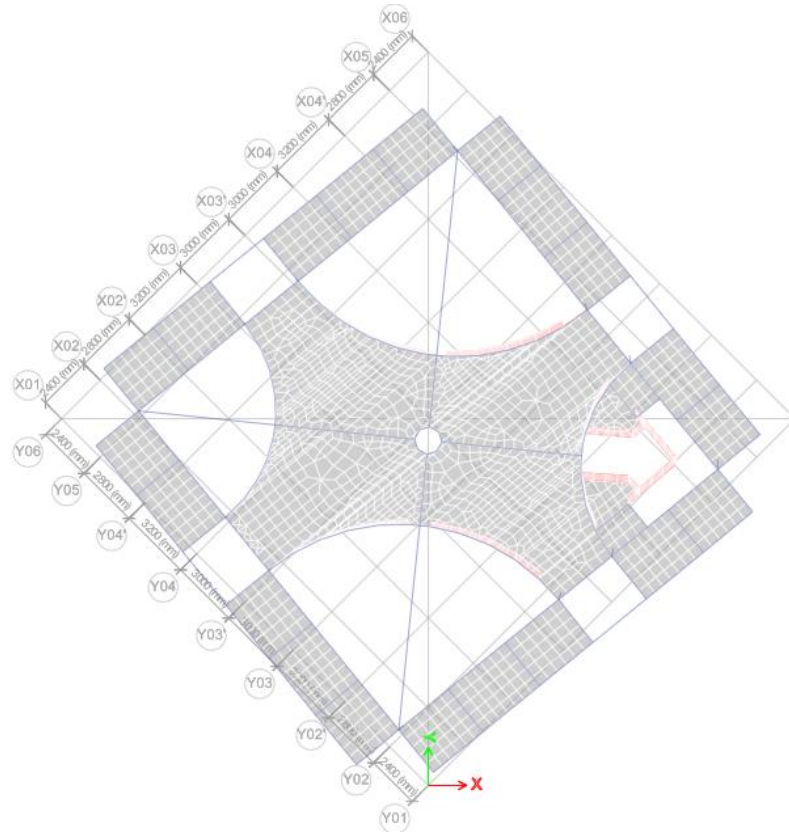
Vista en planta deformada nivel 5 (Modo 3)
